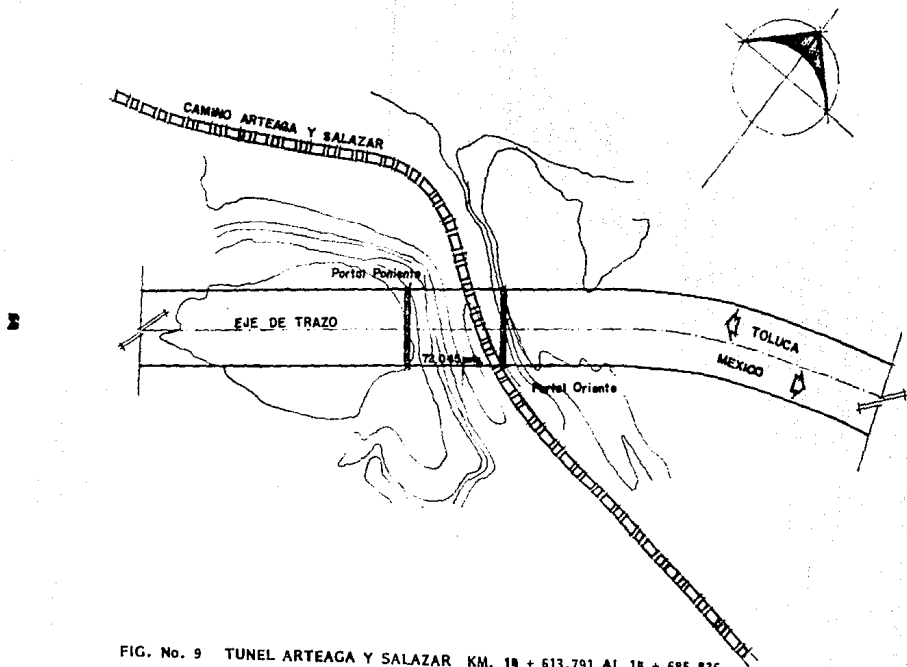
TUNEL ARTEAGA Y SALAZAR KM. 14 + 613.791 AL 14 + 685.836
